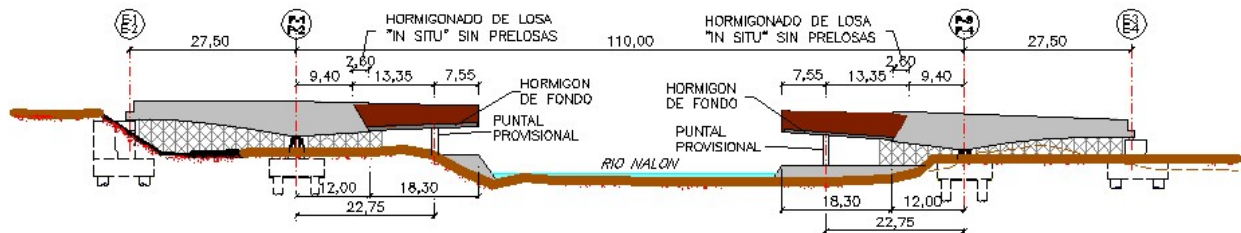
Ejecución de vanos laterales en hormigón, y colocación del primer tramo metálico apeado.
